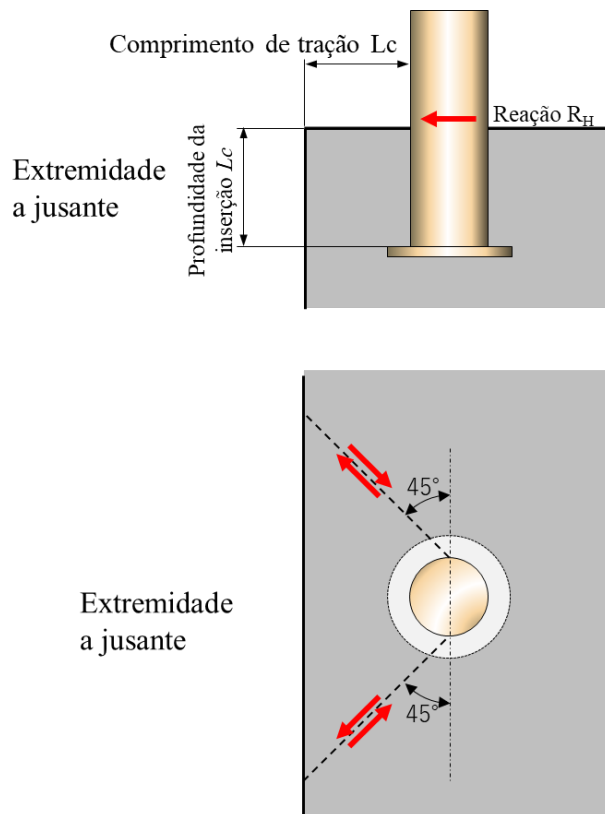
Arrancamento e compressão horizontal no bloco de ancoragem a jusante dos tubos de aço
